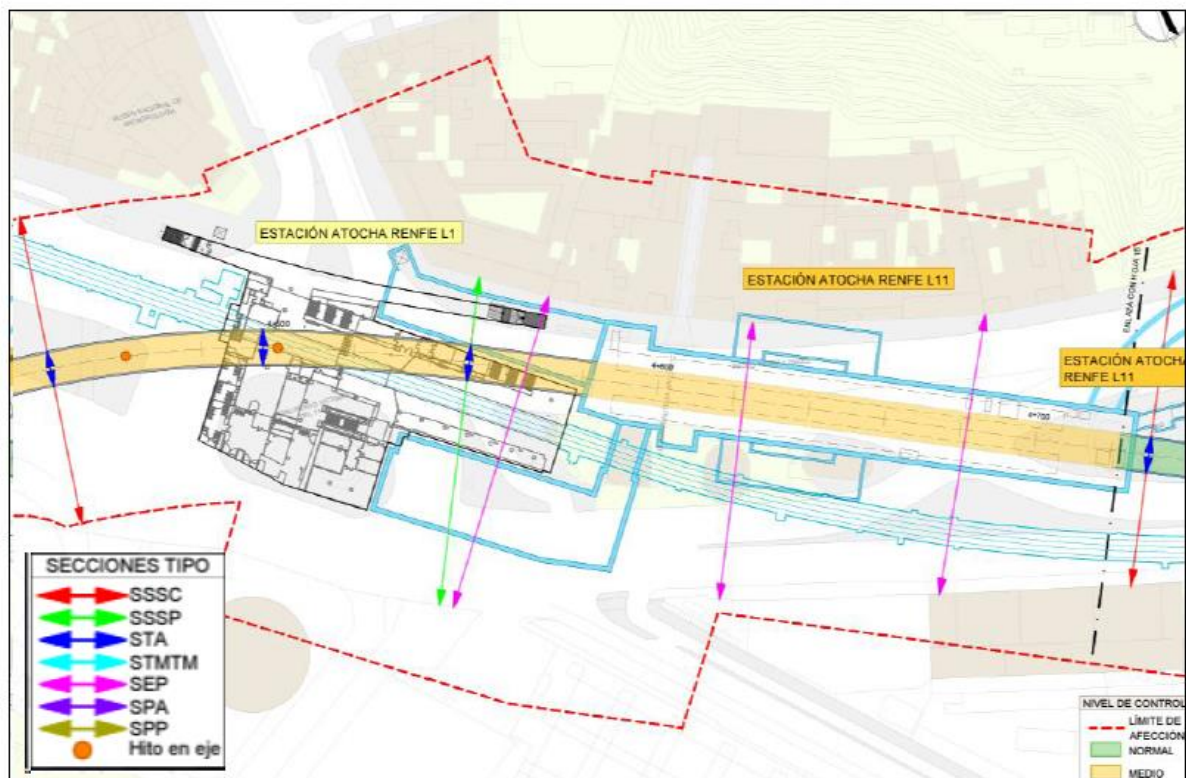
Secciones de auscultación previstas en el Proyecto Constructivo para la estación de Atocha.
